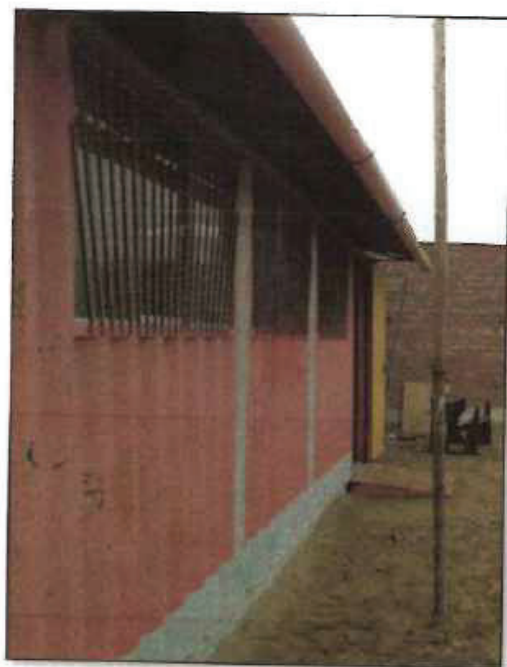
VISTA LATERAL E INTERIOR DEL PABELLON, TIPO CONTAINER, SE OBSERVA RAJADURA EN LOS PISOS DE CONCRETO.
